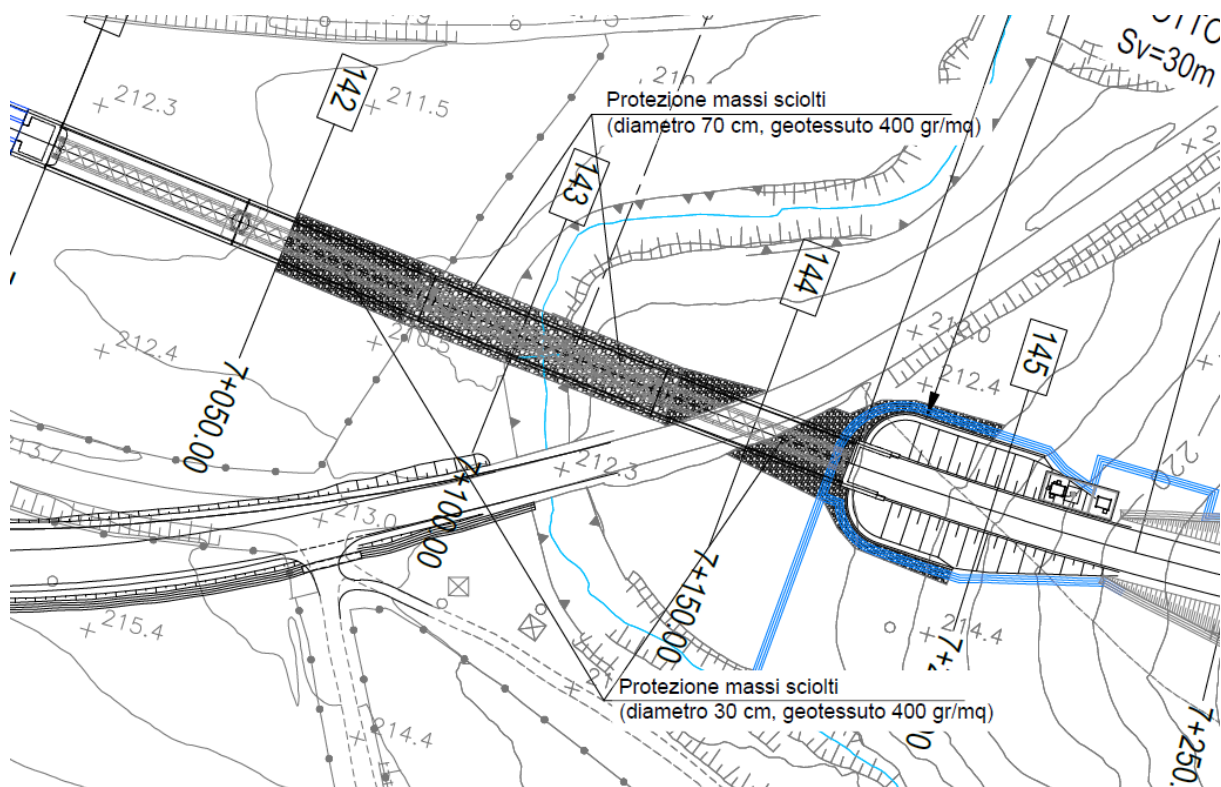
Viadotto VI07: stralcio della planimetria delle opere di sistemazione idraulica.
